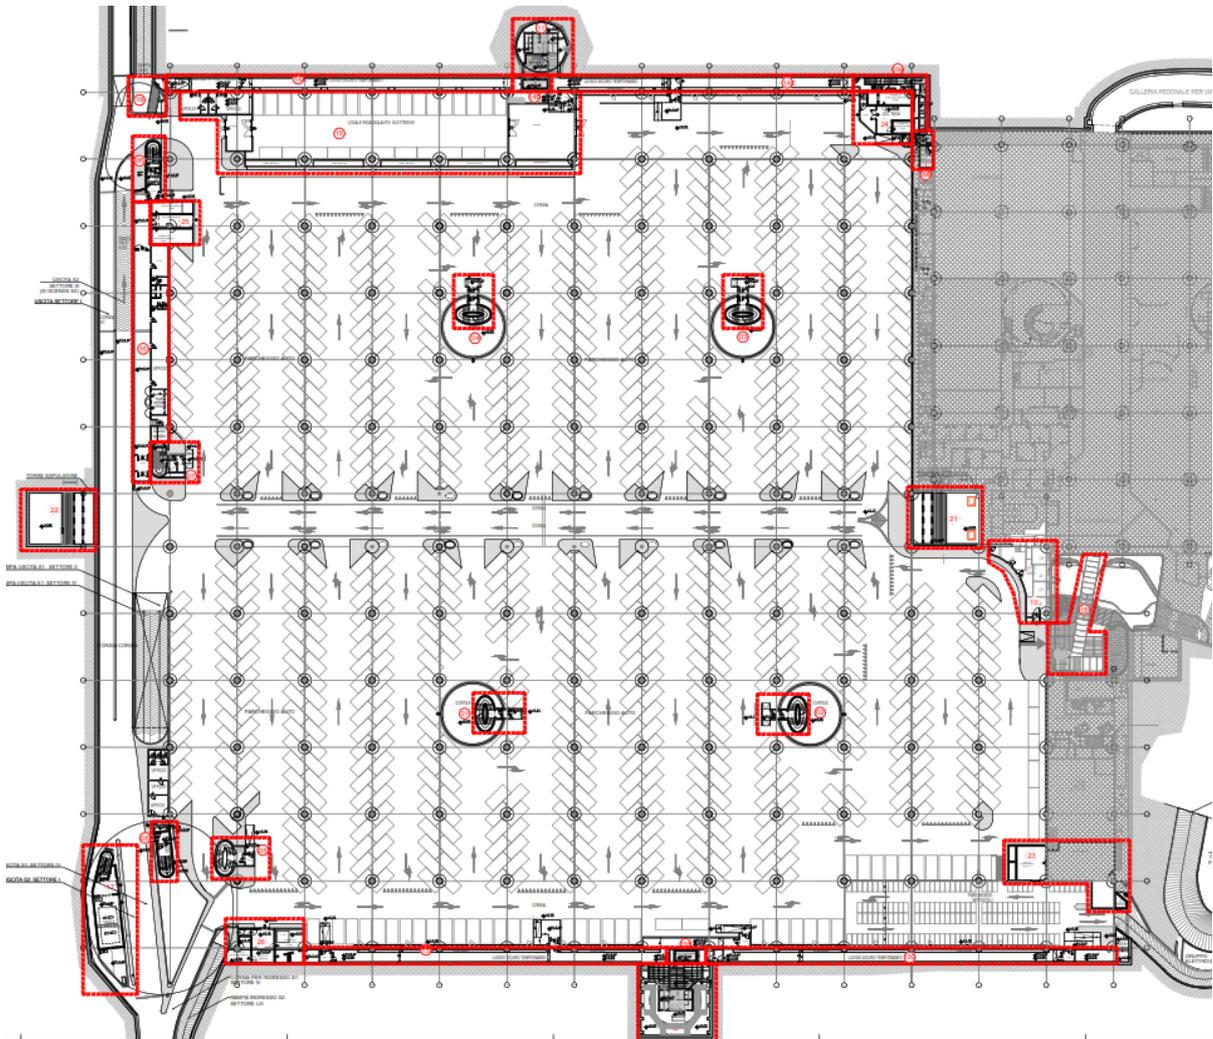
Planimetria Piano S1 -con identificazioni interventi
